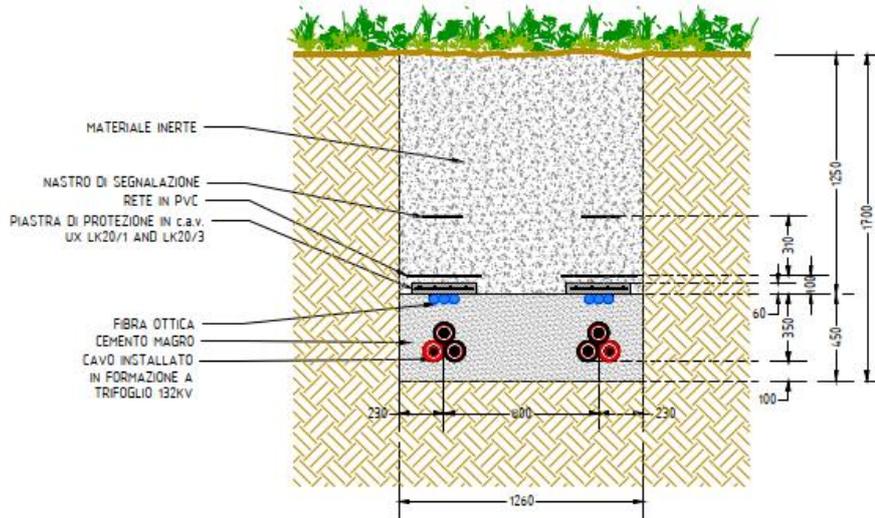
Sezione tipo posa in terreno – Tratto di cavidotto dal punto di giunzione alla SE di Trasformazione.
